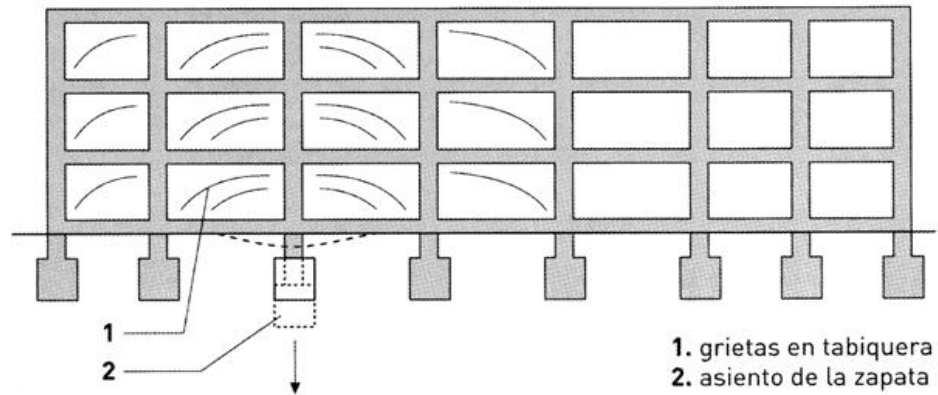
Grietas en tabiquería por asiento de un pilar en pórticos de hormigón armado.
